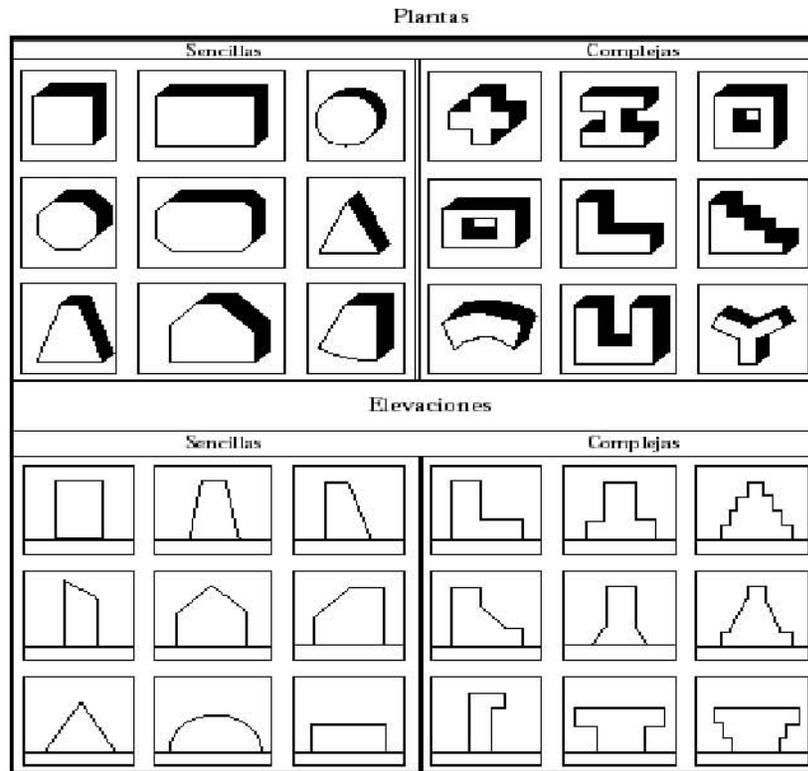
Formas sencillas y complejas en planta y elevación
